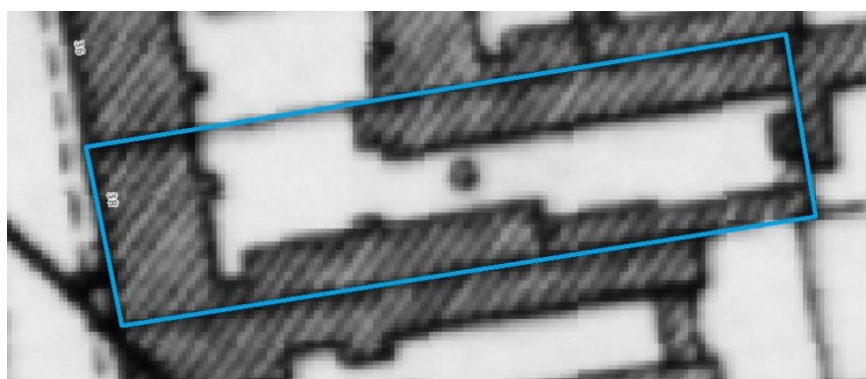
Dokumentacja archiwalna planu zabudowy posesji przy ul. Piotrkowskiej 38 z 1890 r. Widoczna nowa studnia w centrum. Źródło: Archiwa Towarzystwa Kredytowego w Łodzi, dostęp październik 2024, opracowanie własne.
